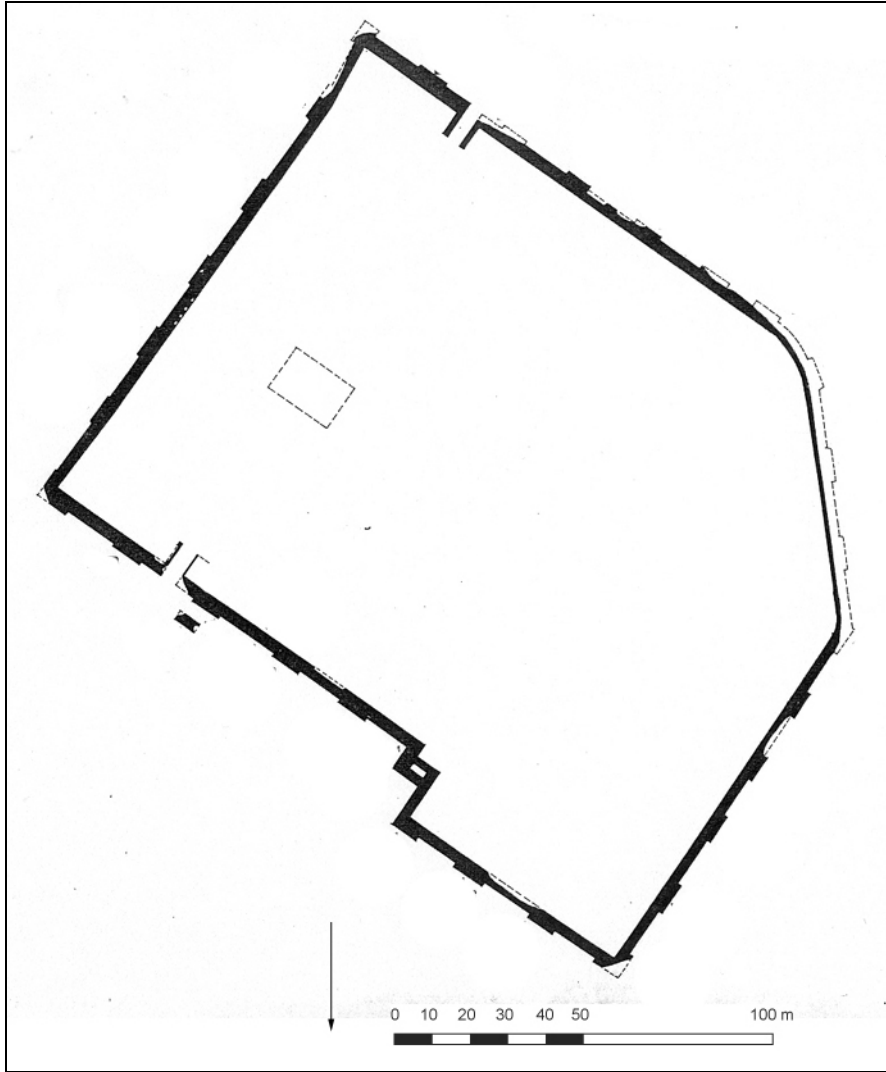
plan de Kharibat Sa'ud (J.-F. Breton, 1985, fig. 4).
